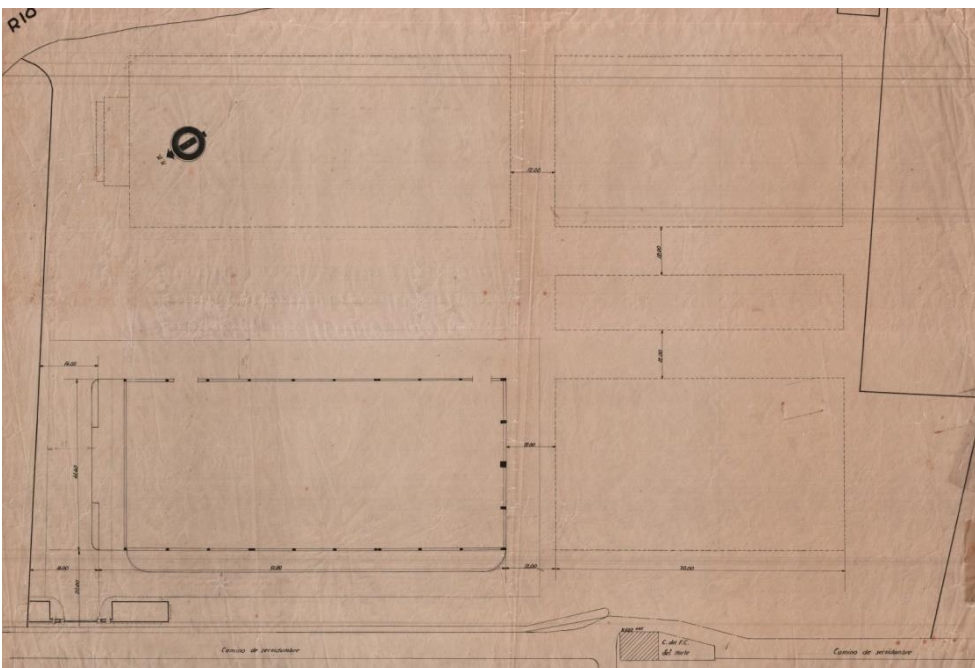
Planta general de la parcela. (AMV 1939-1941)
